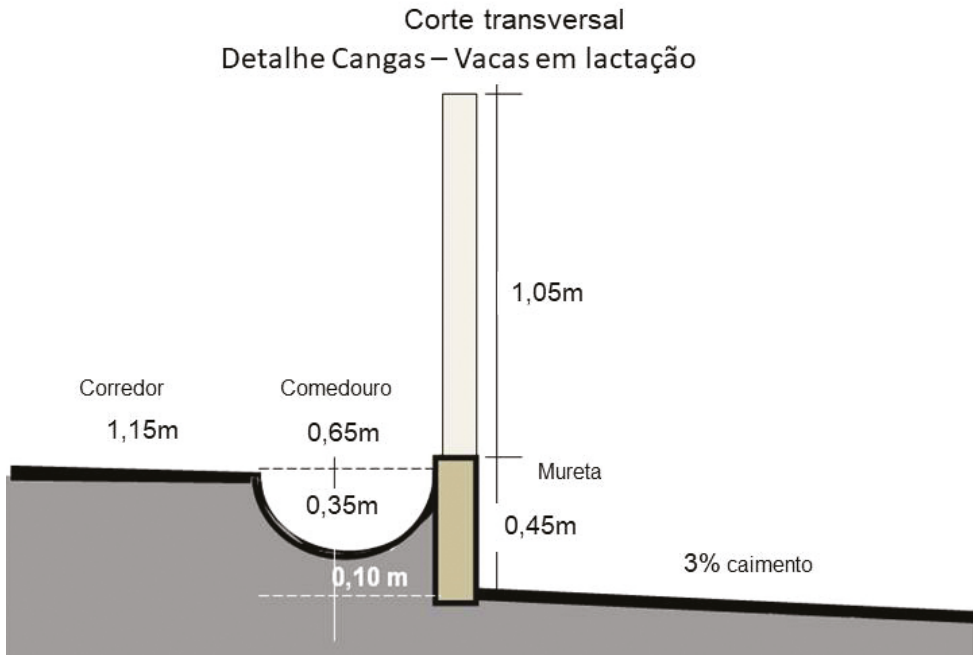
Detalhe de sistema de cangas para vacas (corte transversal), com dimensionamentos recomendados por Carlos Fernandes
